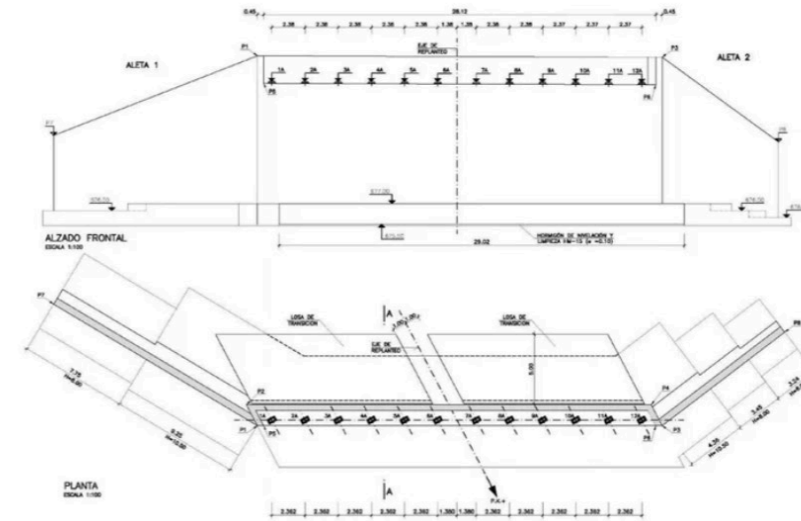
Alzado frontal y planta de un estribo cerrado genérico. Fuente: Blog structuralia.
